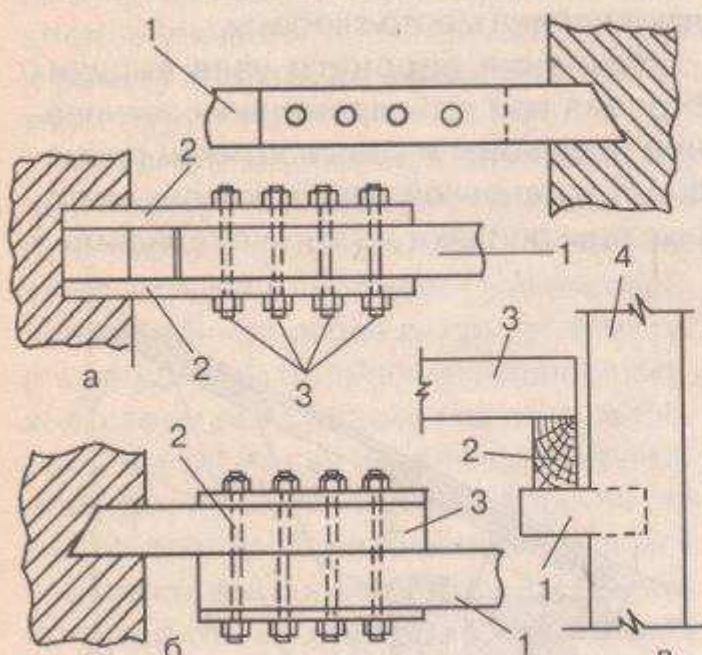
Усиление балки: а — накладками; 1 — балка; 2 — боковые накладки; 3 — болт; б — шипом с новым оголовком; 1 — балка; 2 — болт; 3 — шип с новым оголовком; в — консолью; 1 — консоль; 2 — прогон; 3 — балка с удаленной опорной частью; 4 — стена
